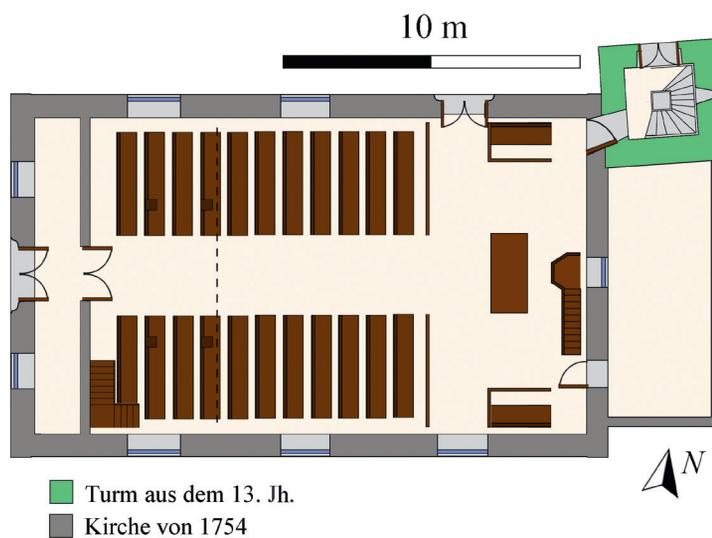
Der Grundriss der protestantischen Kirche (fs).
